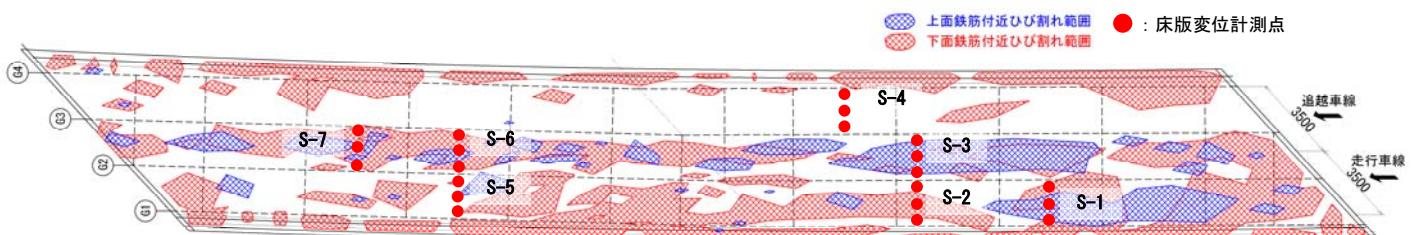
床版内部ひび割れ図（床版切断面ひび割れから推定）
